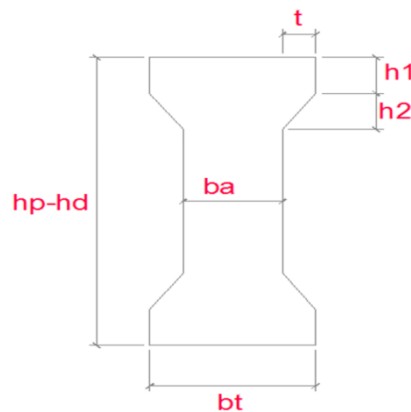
Dimensions d'une poutre en BA du tablier de la variante 1
